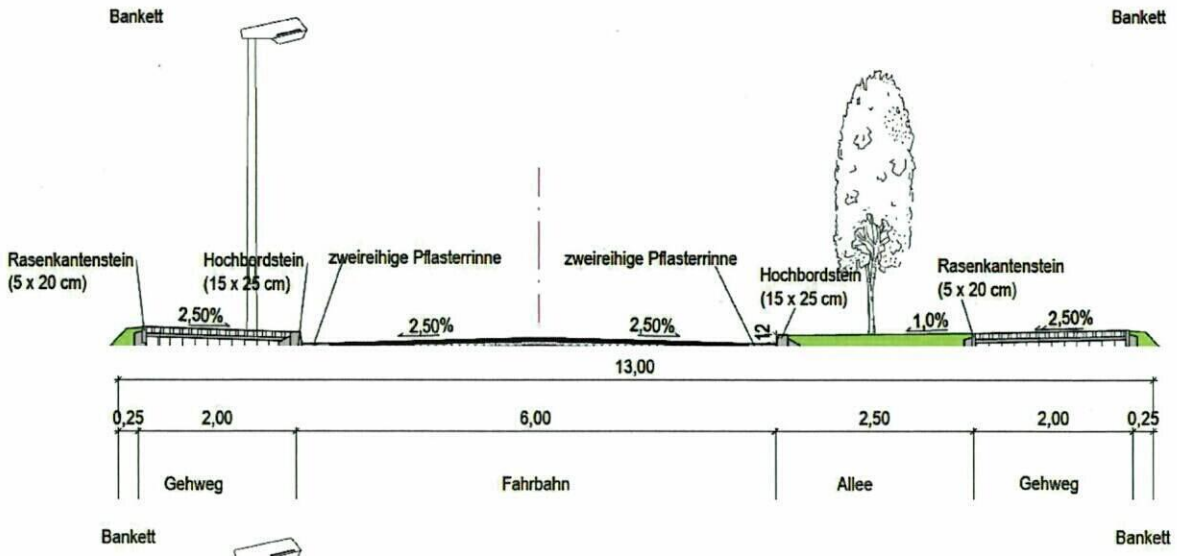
Querschnitt Planstraße A.1 (Sammelstraße mit Busverkehr)
